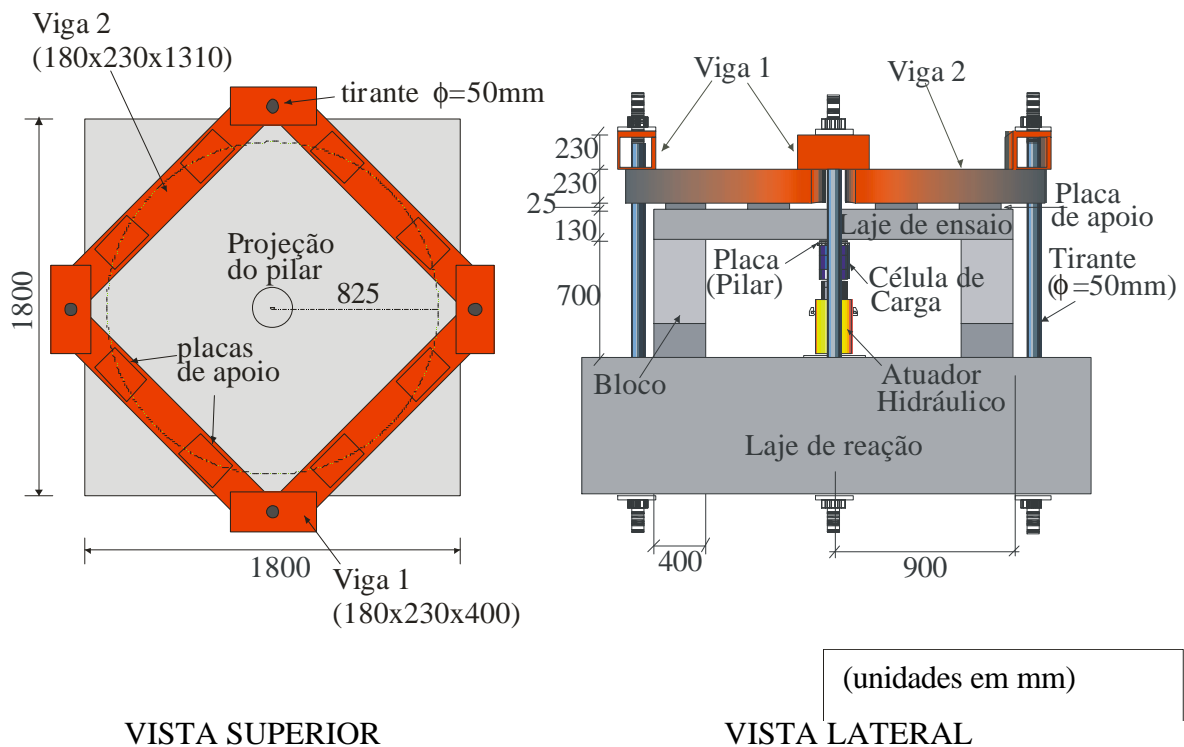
Esquema de ensaio utilizado (vista superior e vista lateral) – (SILVA, 2003)
